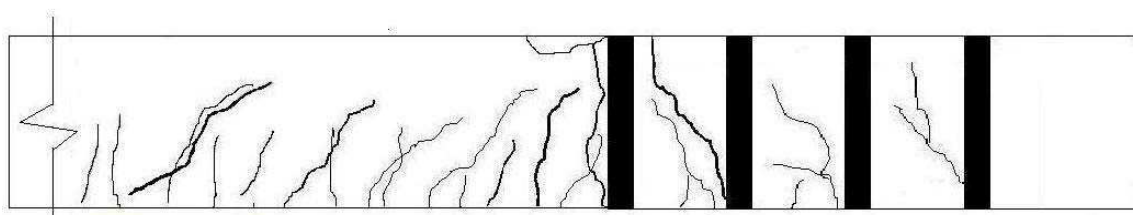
Panorama de fissuração da Viga V27.
